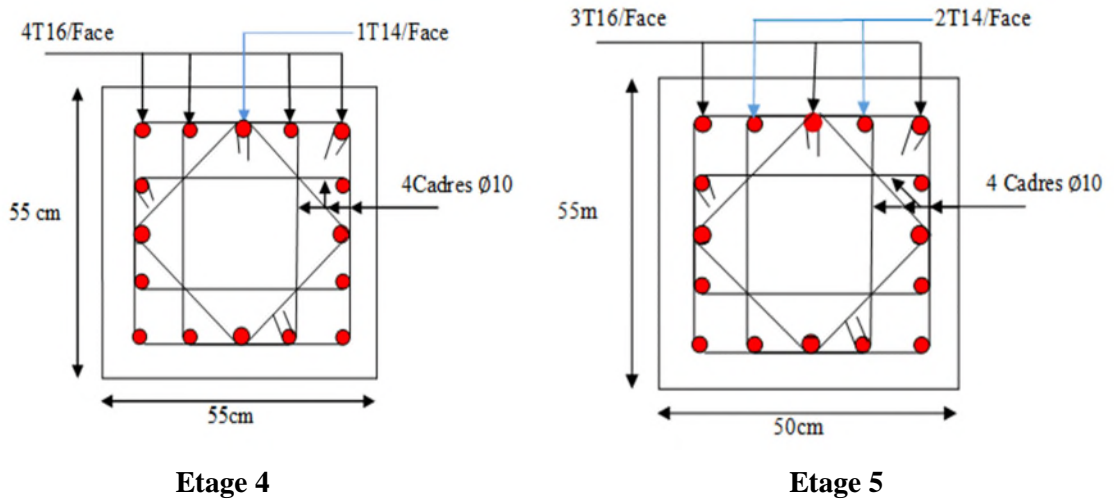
Schéma de ferrailage des poteaux des étages 4 et 5
